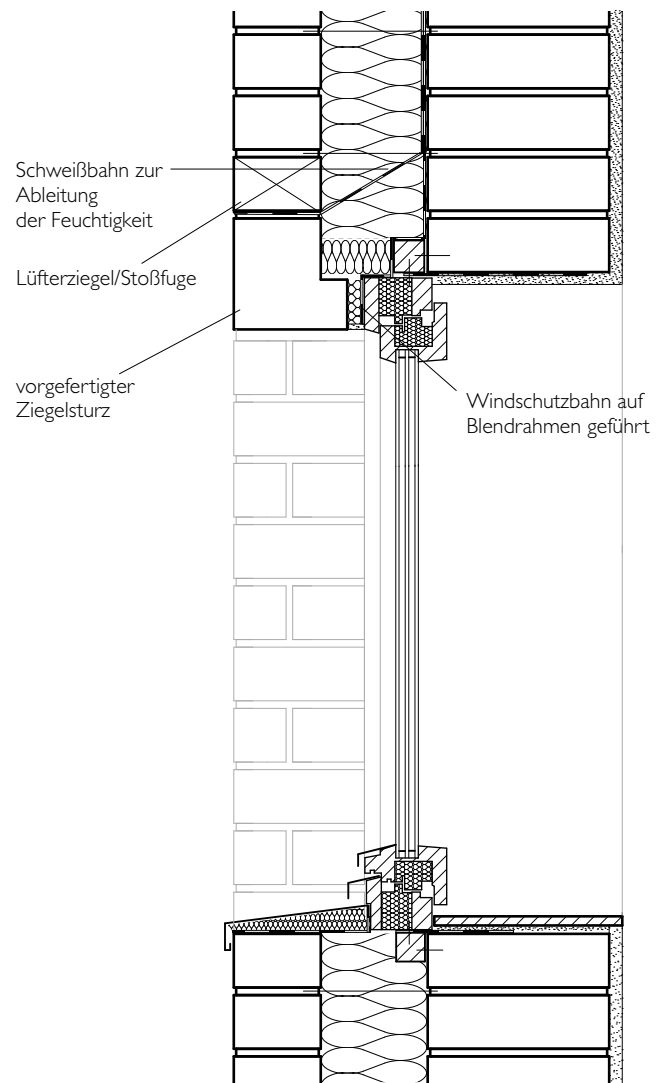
Fensterdetail, Kerndämmung mit Vorsatzschale neu, M 1:10
